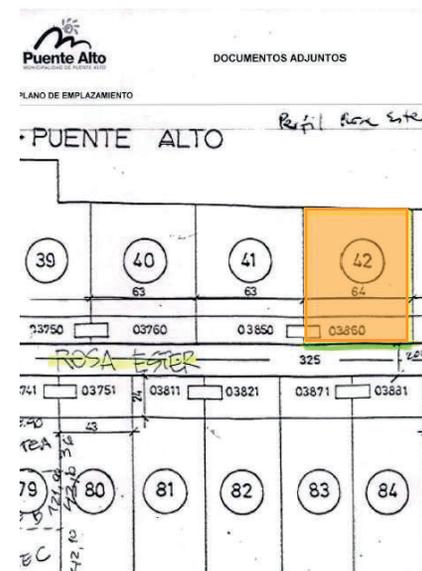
Certificado de informes previos Rosa Ester #3860, Puente Alto, 2018. Fuente Municipalidad de Puente Alto
